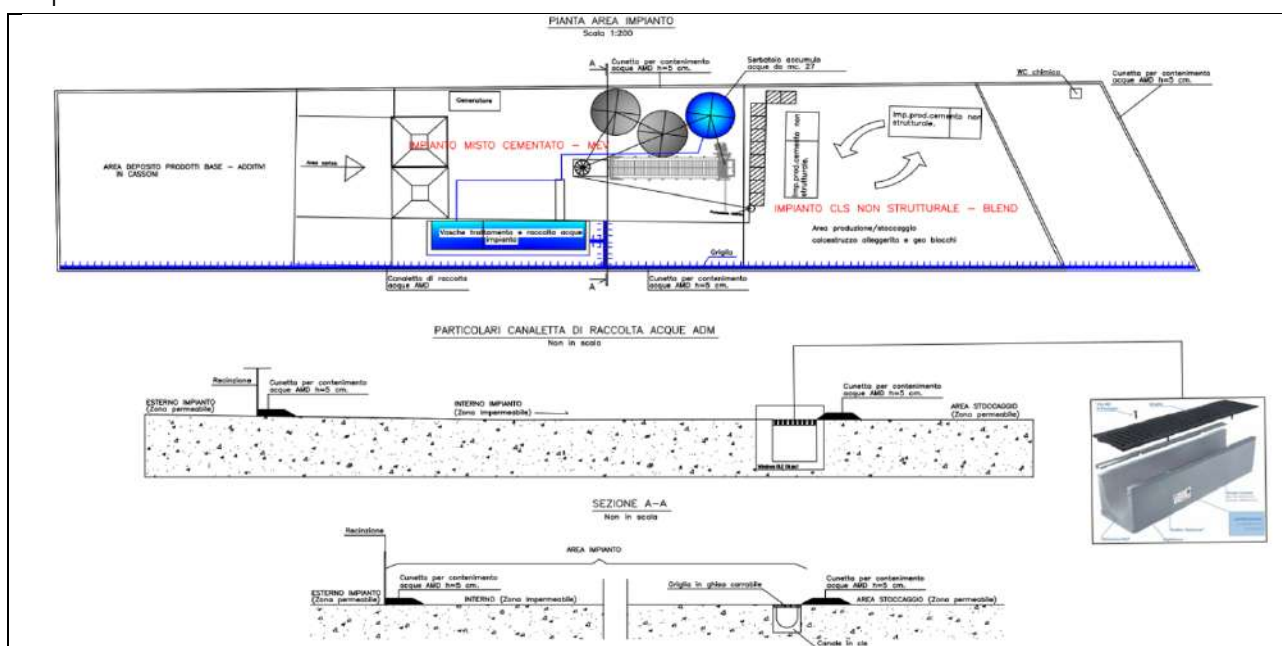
Sistema di raccolta e trattamento AMD dell' area impianto misto cementato e calcestruzzo non strutturale
